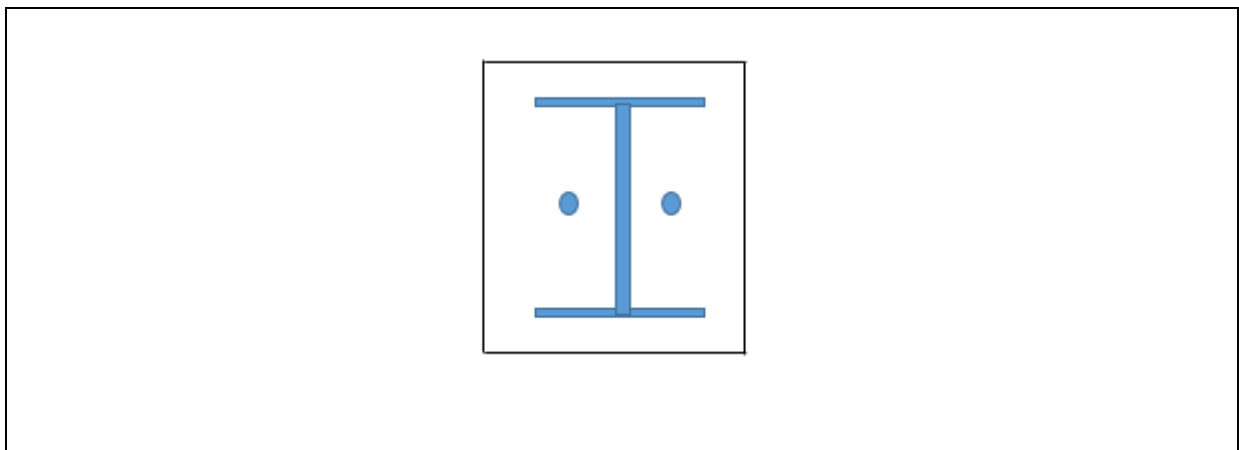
Représentation de l'assemblage Poteau –poutre sablière.
